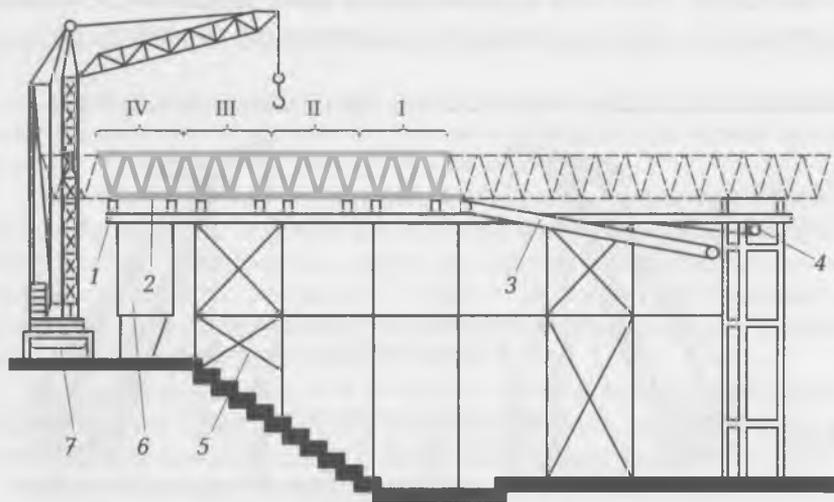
Монтаж структурного покрытия движкой с наращиванием:
